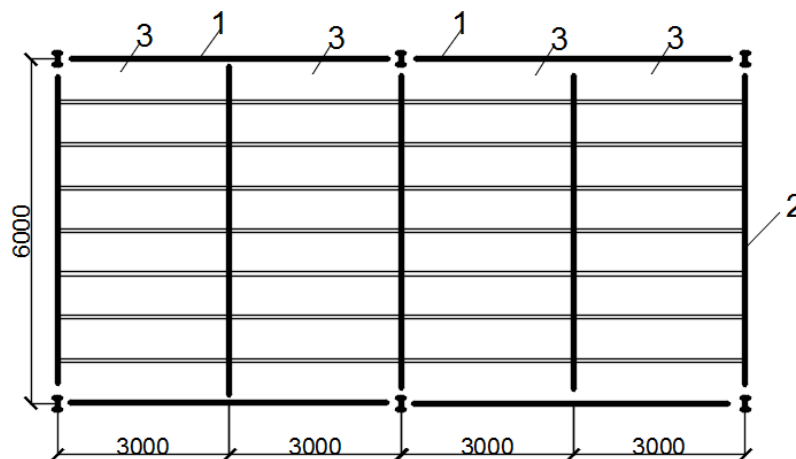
Схема балок перекрытия с сеткой колонн 6x6. 1 – балки каркаса, 2 – балки из составного профиля, 3 – плита профнастила.
